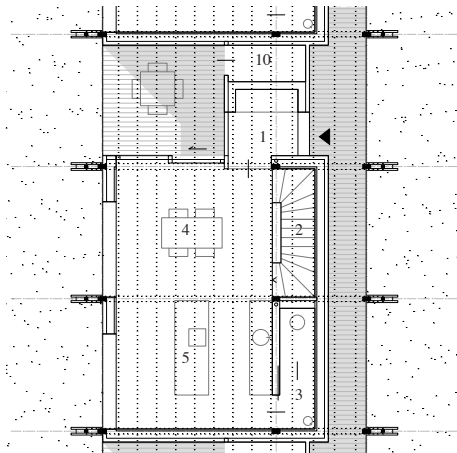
Typ B.2 Regelwohnung Maisonette Grundrisse
